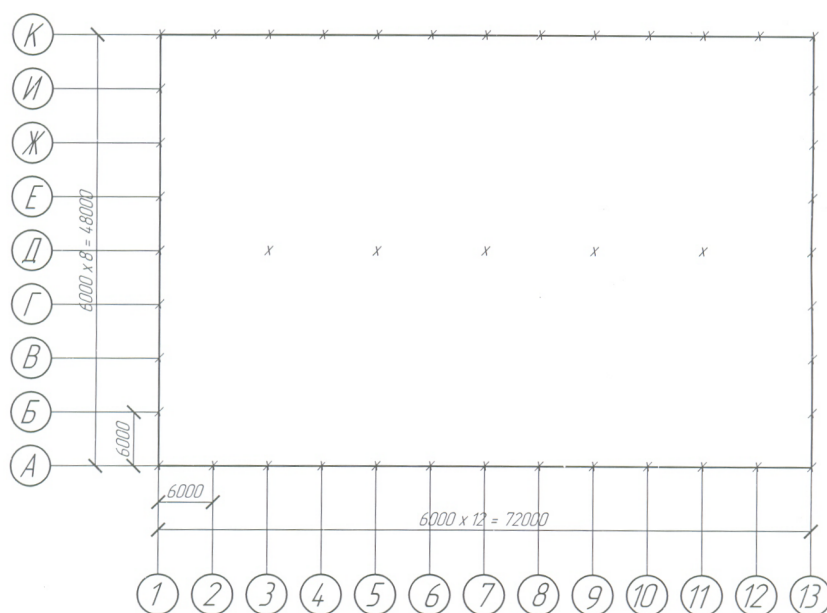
Нанесение размеров и координатной сетки на чертеже планировки производственного корпуса
